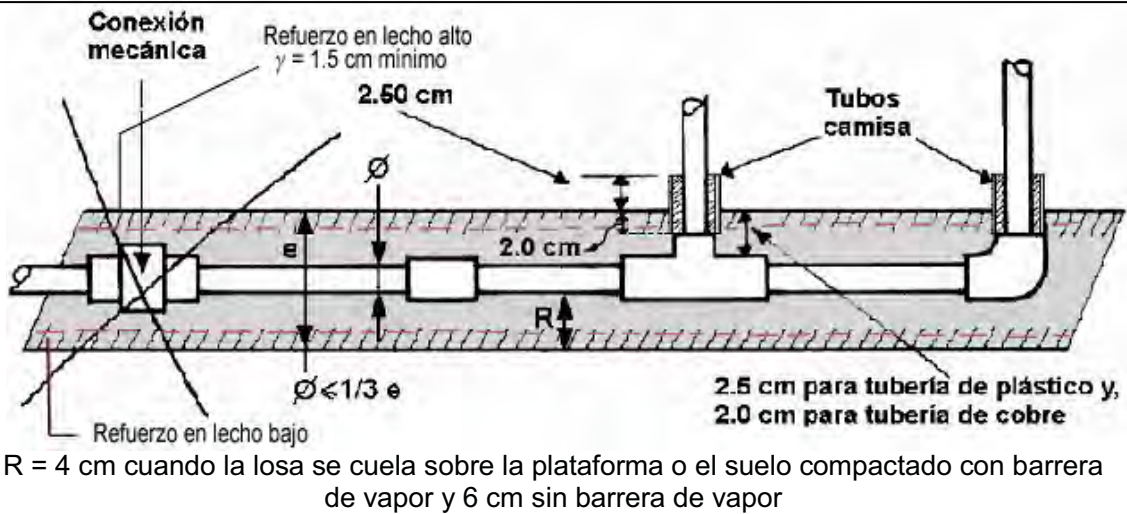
TUBERÍA AHOGADA EN LOSAS DE CONCRETO ARMADO
